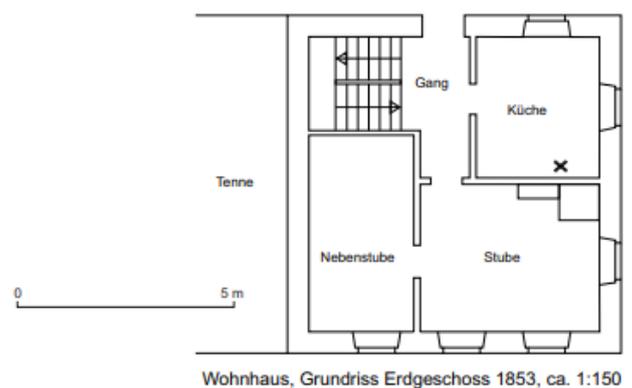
Grundriss Erdgeschoss mit der Raumdisposition, ca. 1:150.
